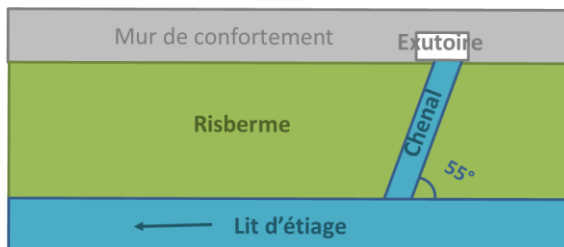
Aménagement de la risberme au droit des exutoires pluviaux en pied de mur
